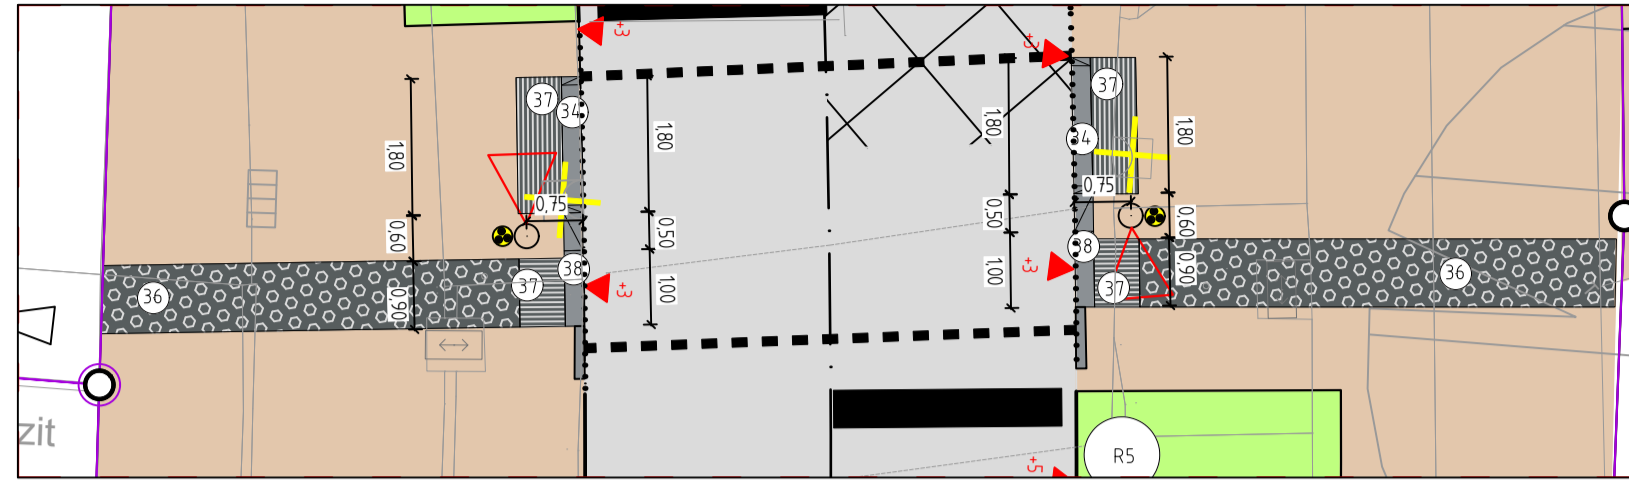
Planung-Taktile Elemente (Fußgänger-Querung)
